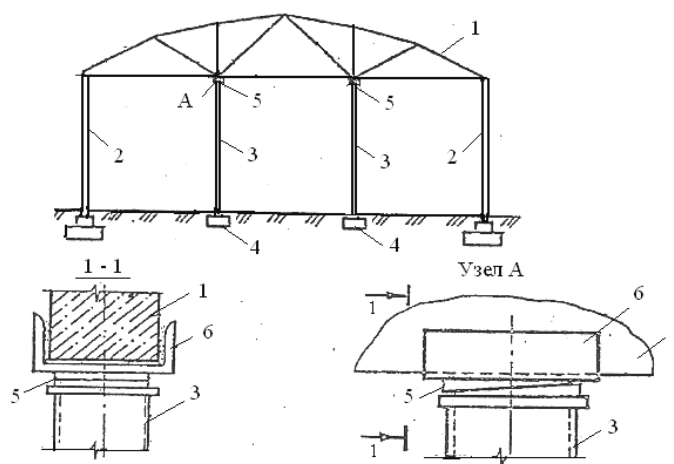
Усиление железобетонной фермы установкой дополнительных опор: 1 - усиливаемая ферма; 2 - существующие колонны; 3 - дополнительные опоры; 4 - фундамент под дополнительные опоры; 5 - приспособления для включения дополнительных опор в работу; 6 - опорный элемент
